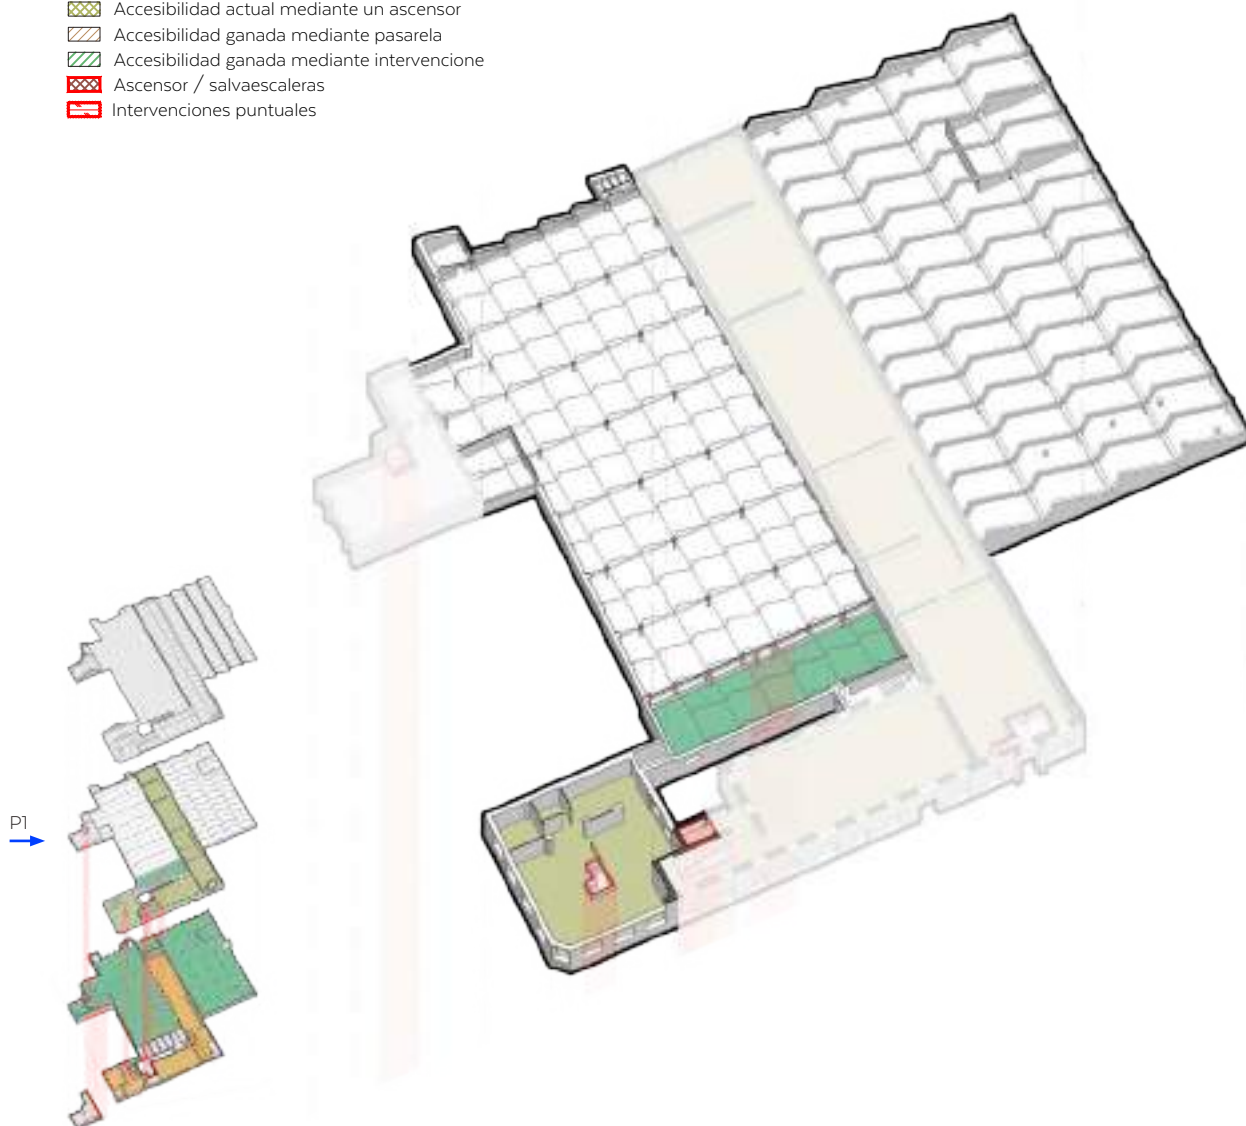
Accesibilidad propuesta. Axonometría de planta primera
